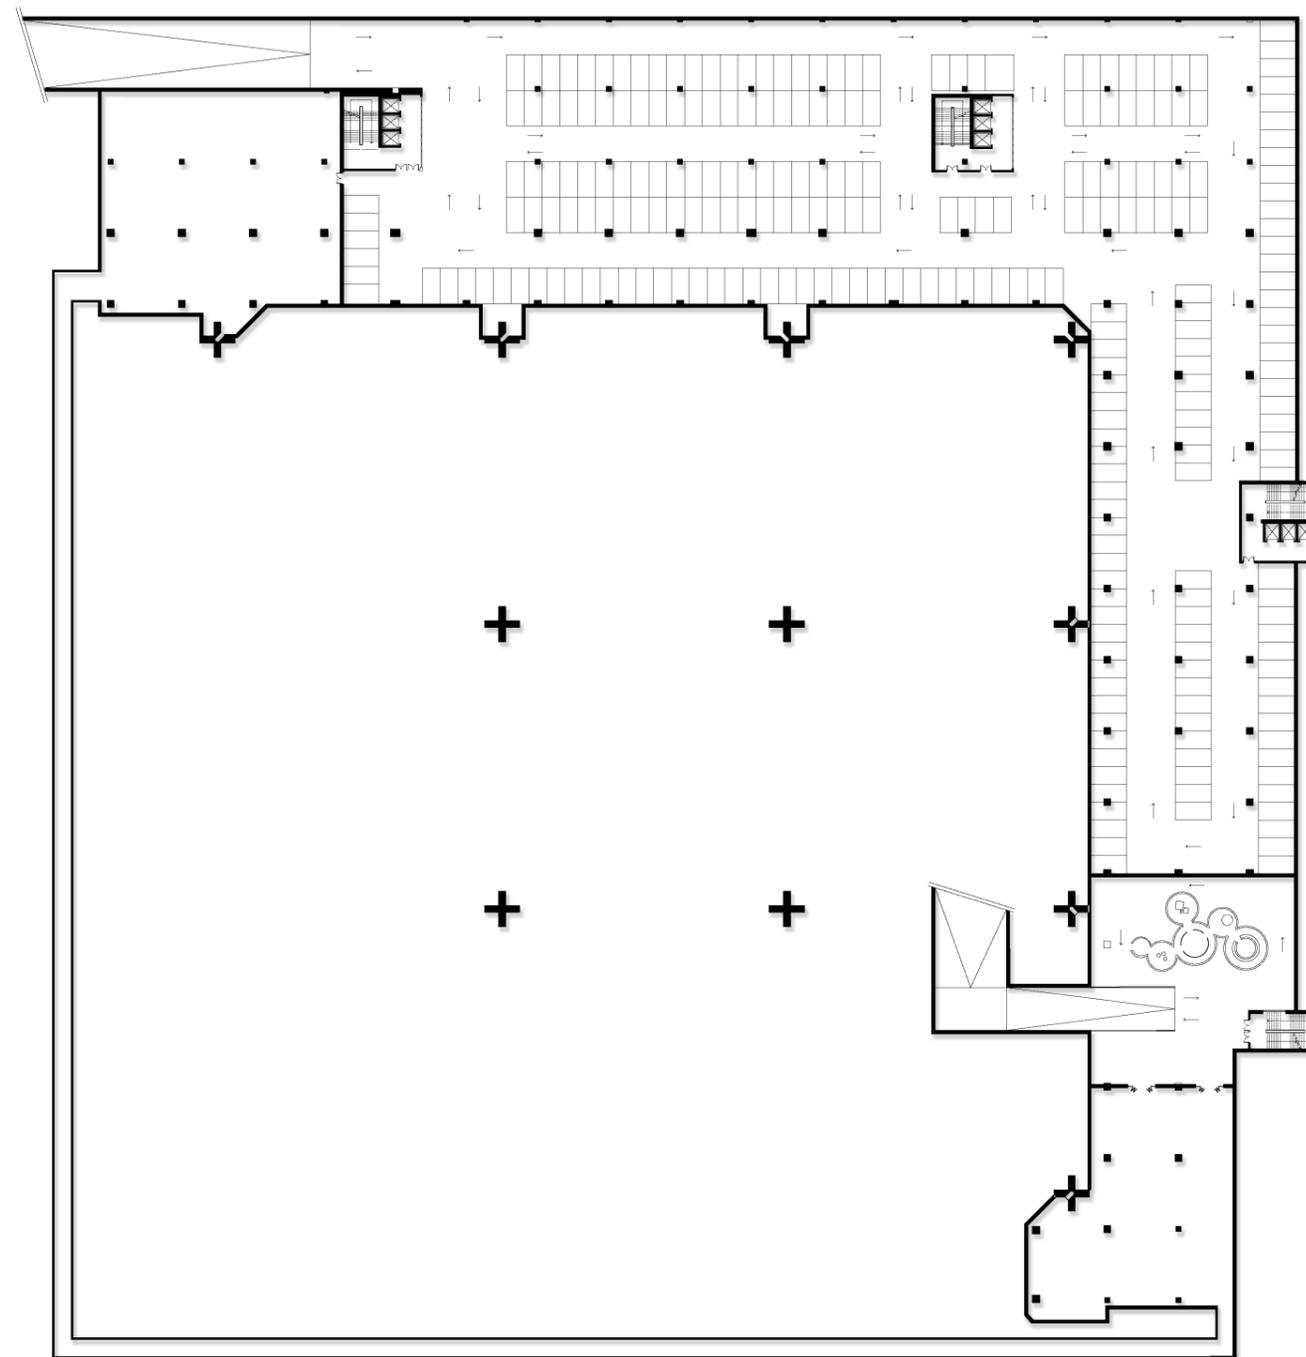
Pianta piano interrato dell'intervento Disomogeneità Omogenea, elaborato degli autori.
